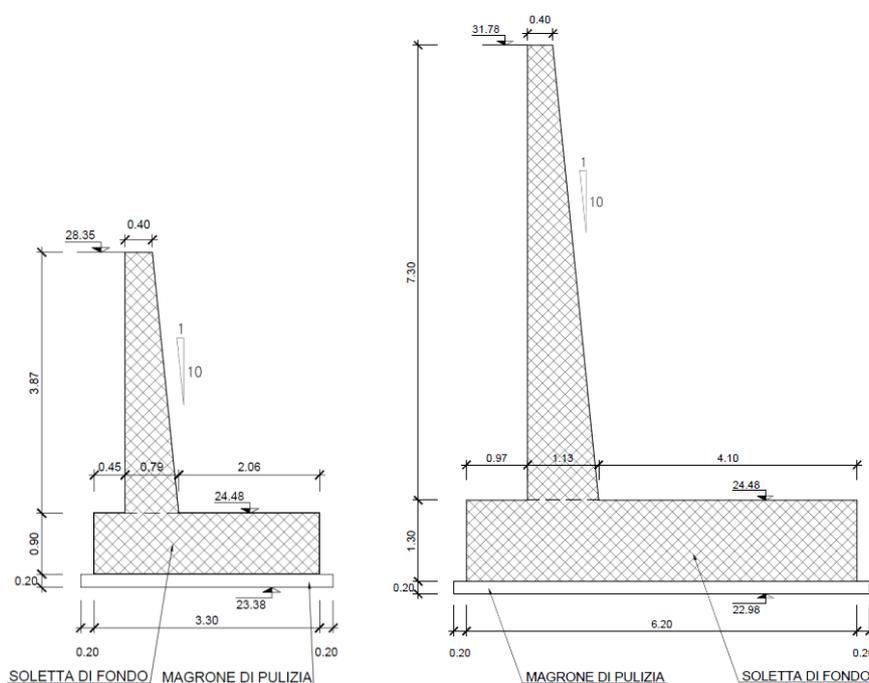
Muro tipo 1 (a sinistra) – muro tipo 2 (a destra)
